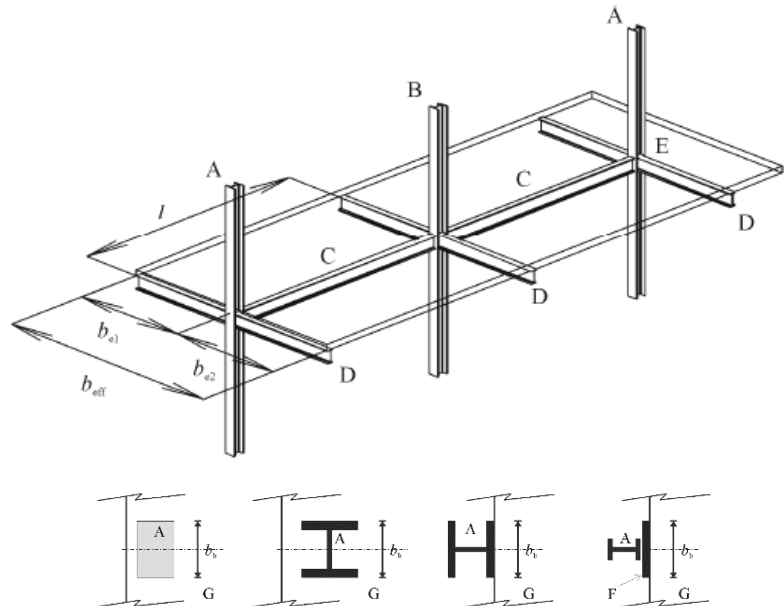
Tipos de elementos em estruturas porticadas [9].
